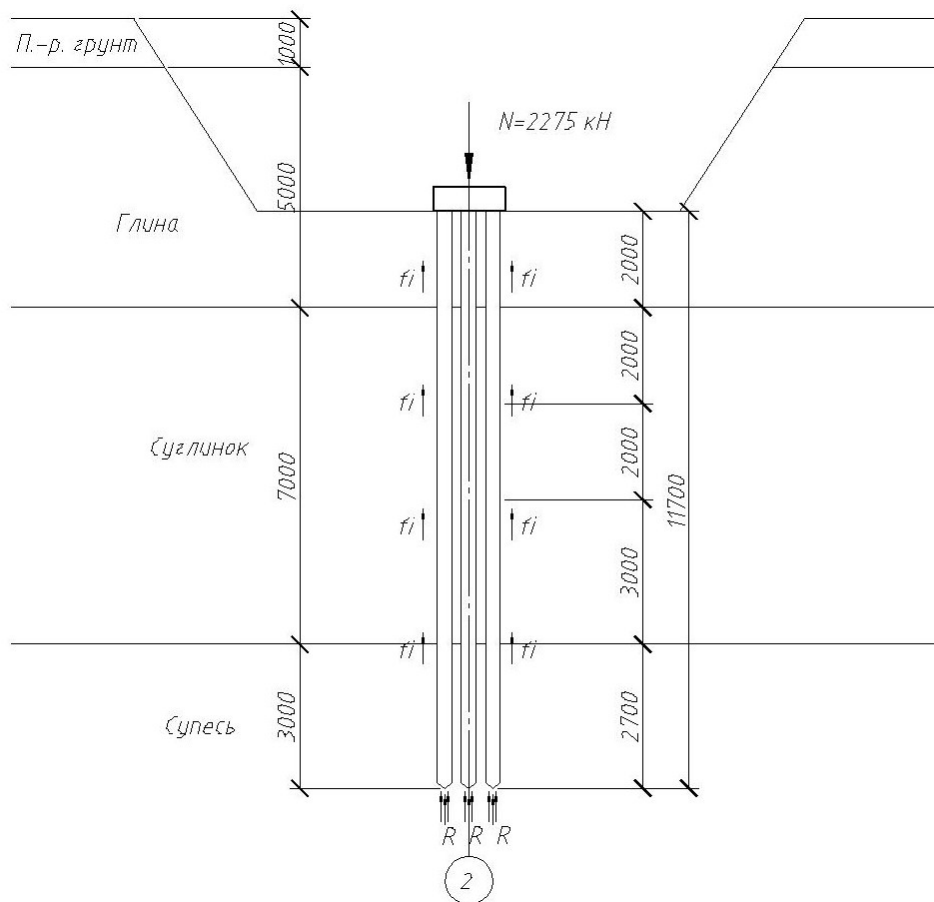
Расчетная схема свайного фундамента под колонну среднего ряда
